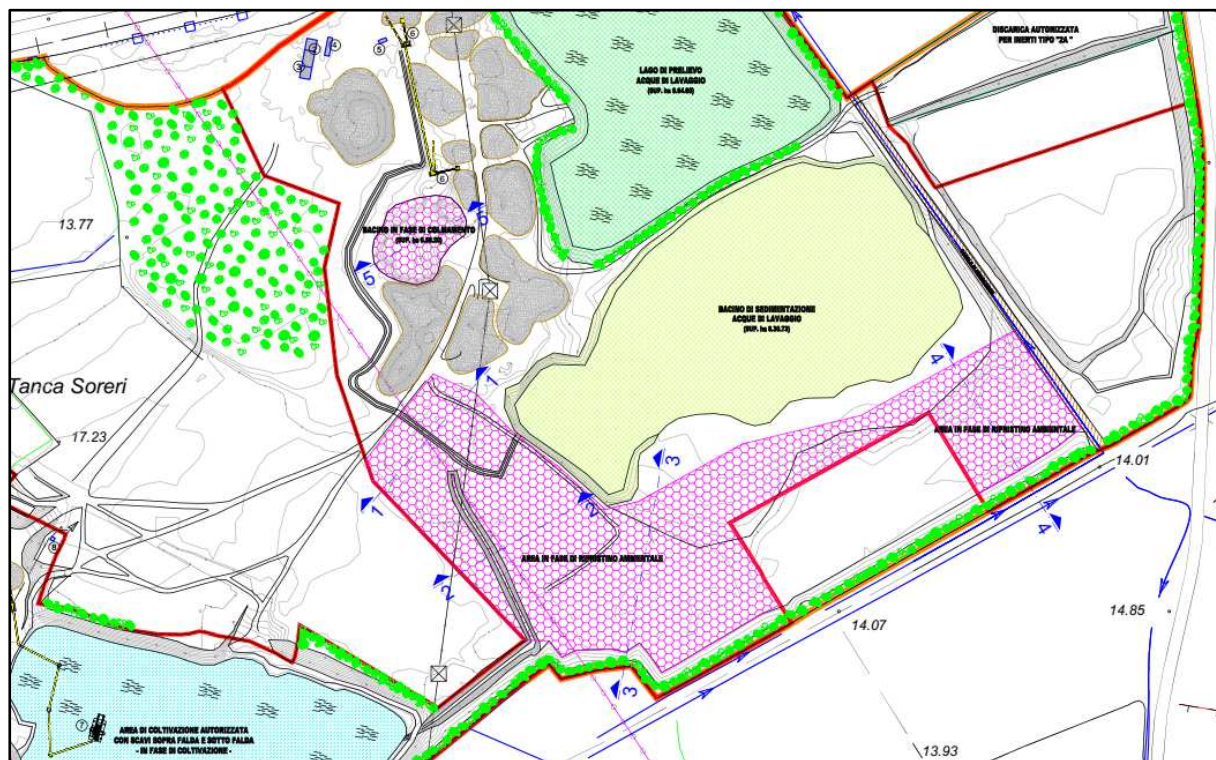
STRALCIO PLANIMETRICO - PROCEDIMENTO PAUR
